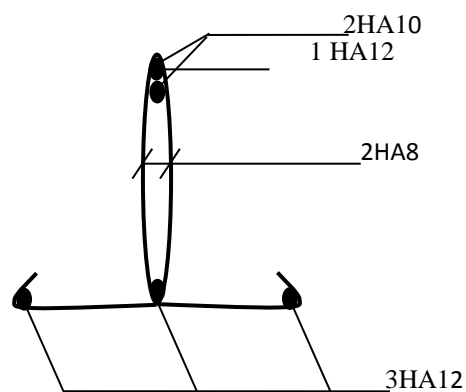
Plan de ferrailage de la poutrelle au niveau des appuis
